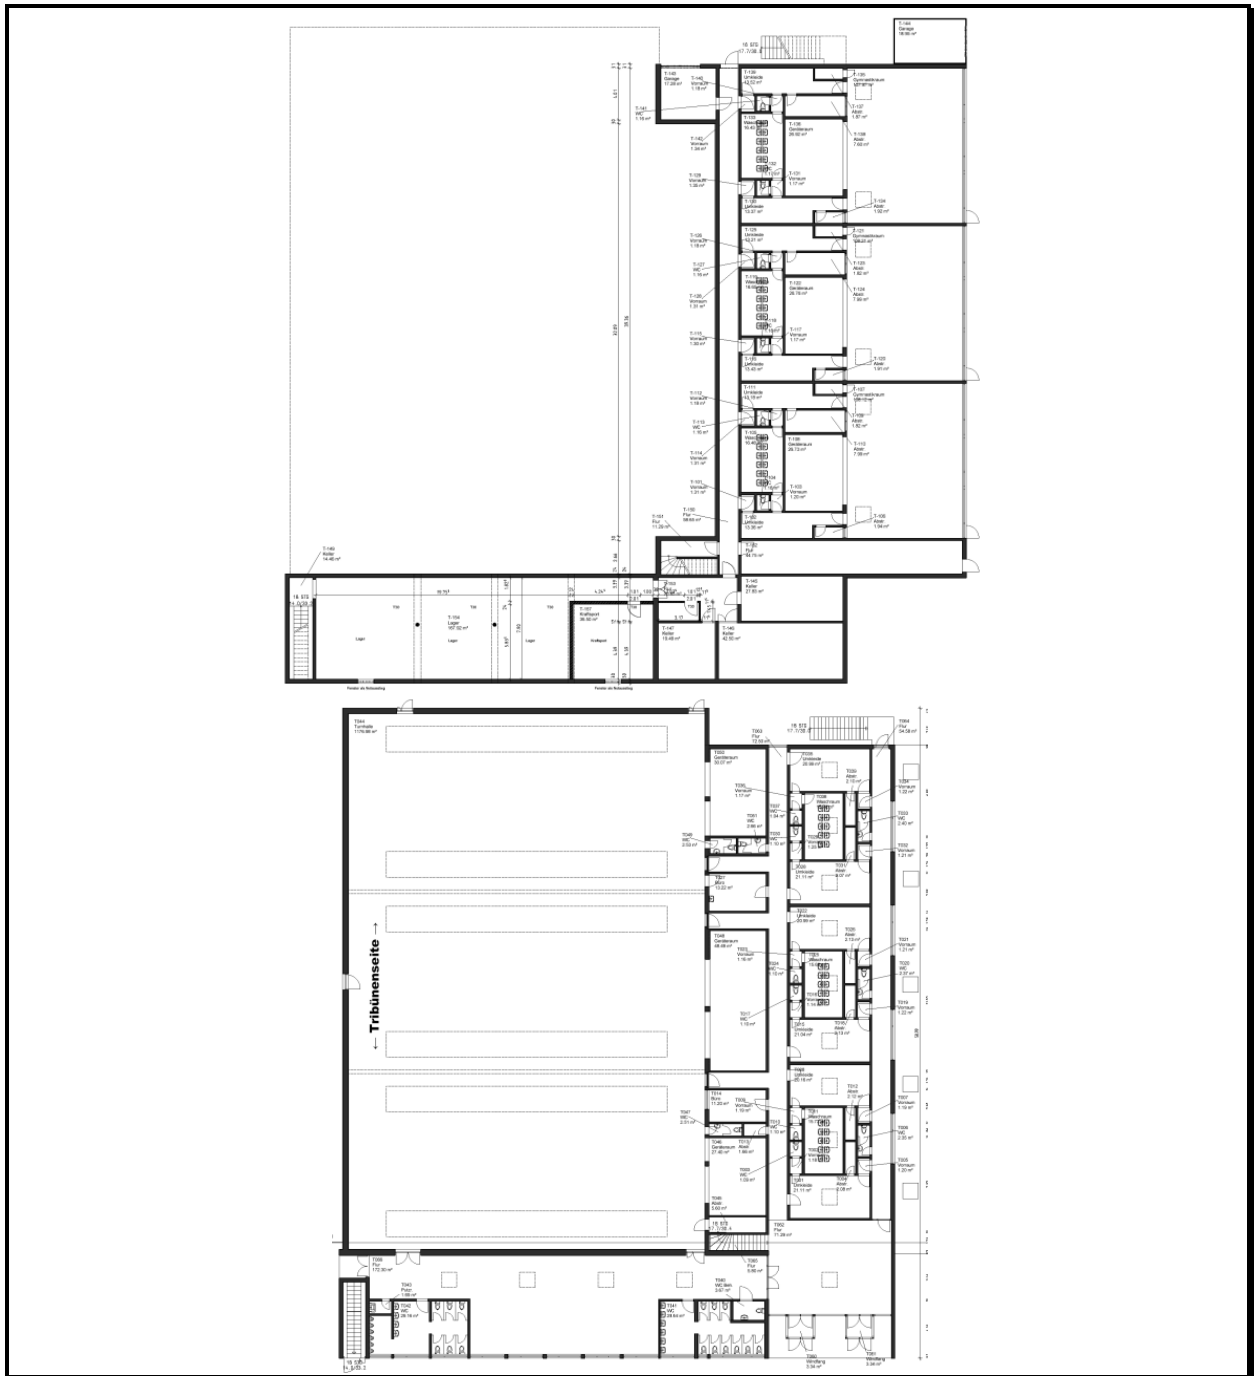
Ernst-Mach-Gymnasium: Grundriss Sporthalle UG (oben) und EG (unten)
